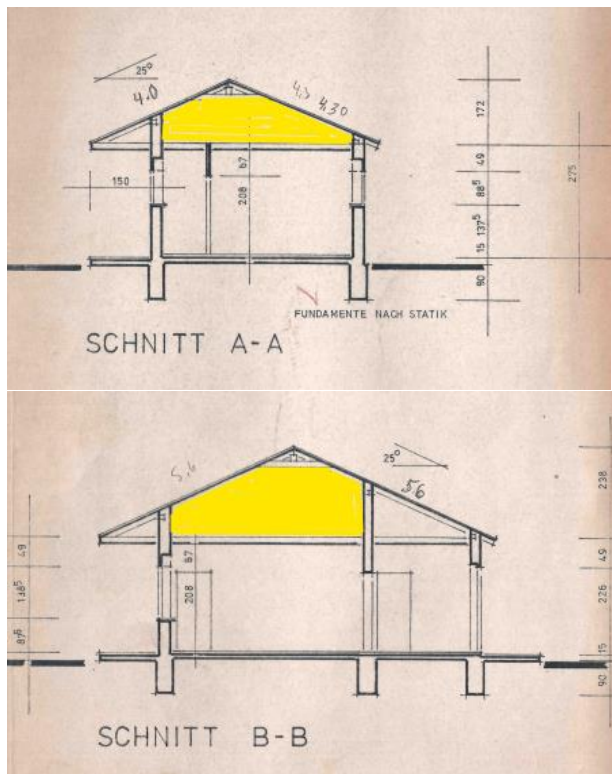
/16: Schnitte des Umkleidegebäudes, inkl. Dachgeschoß
